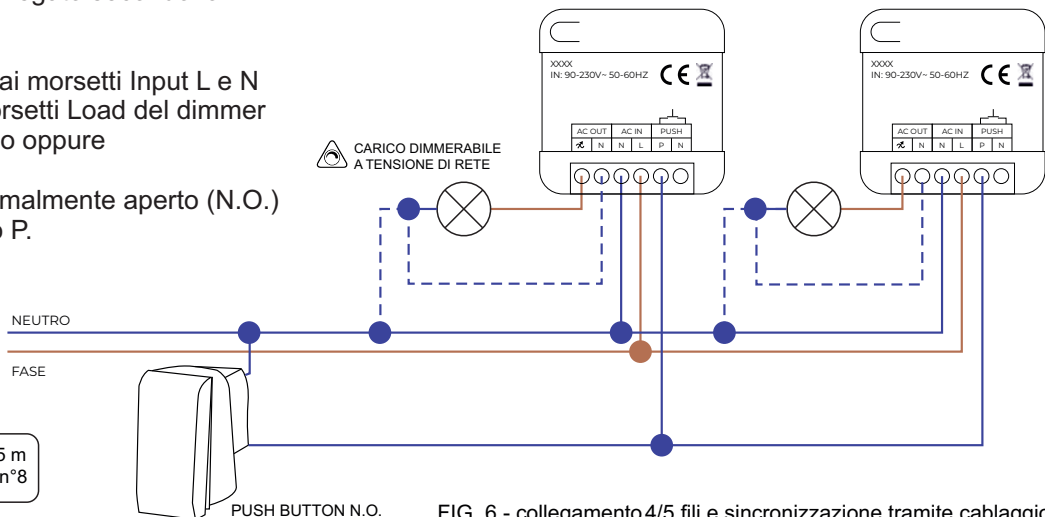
collegamento 4/5 fili e sincronizzazione tramite cablaggio
